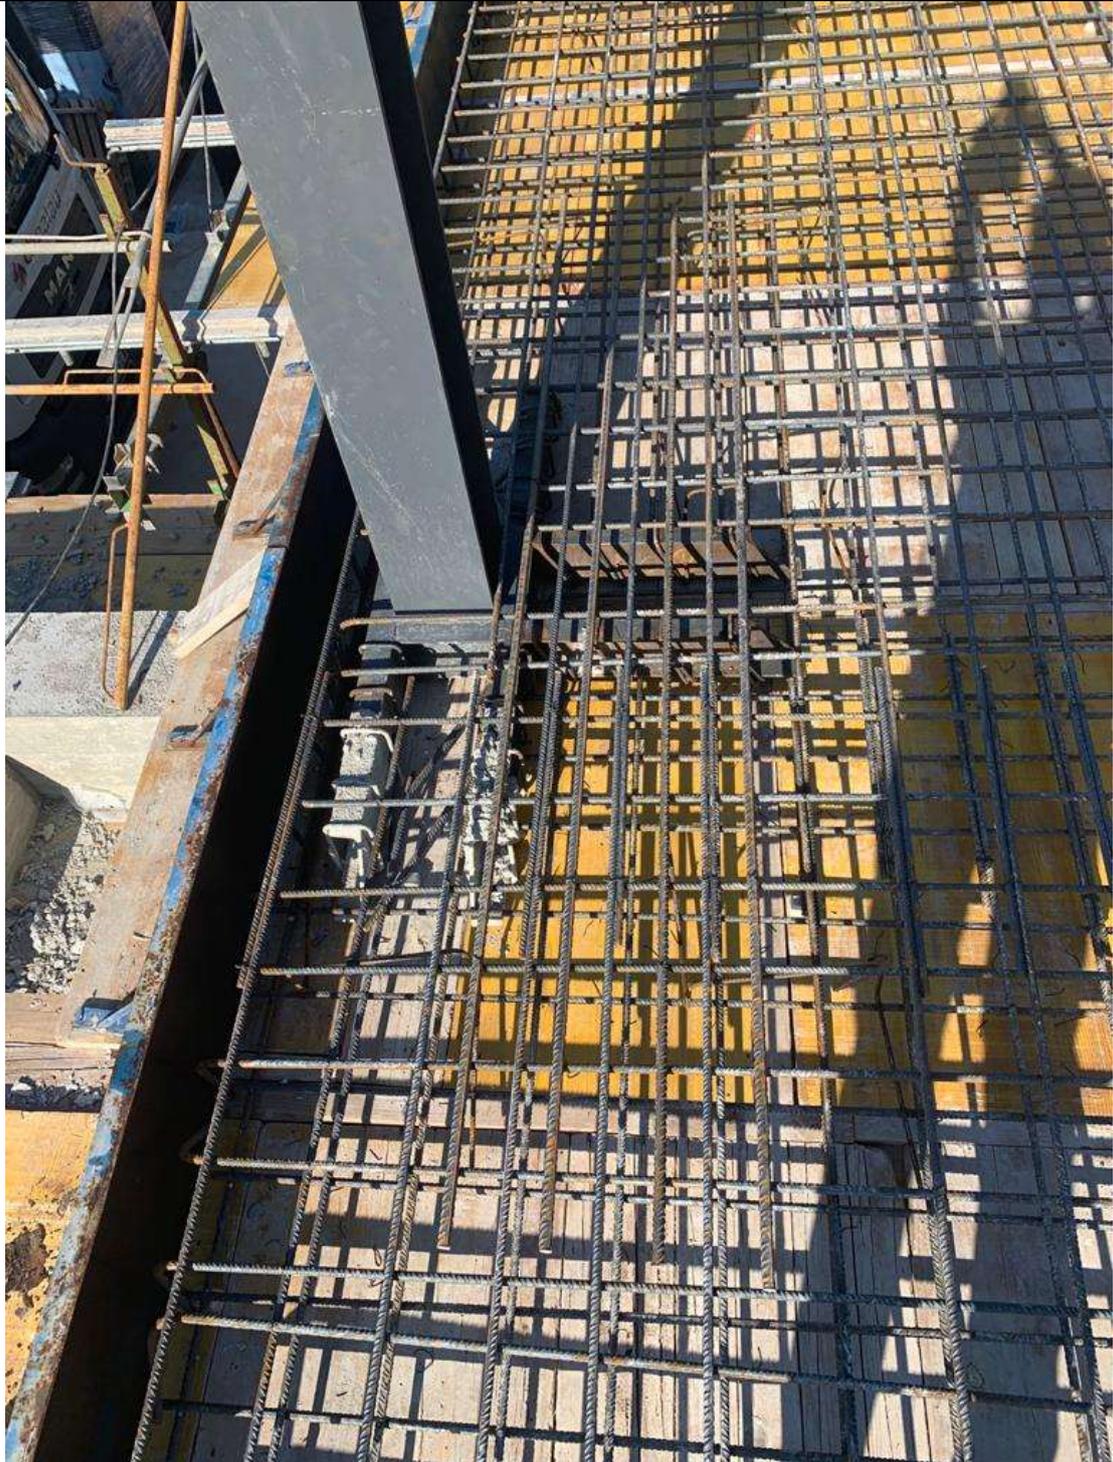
Refuerzo cruceta pilar-forjado. 2020. Fuente propia
